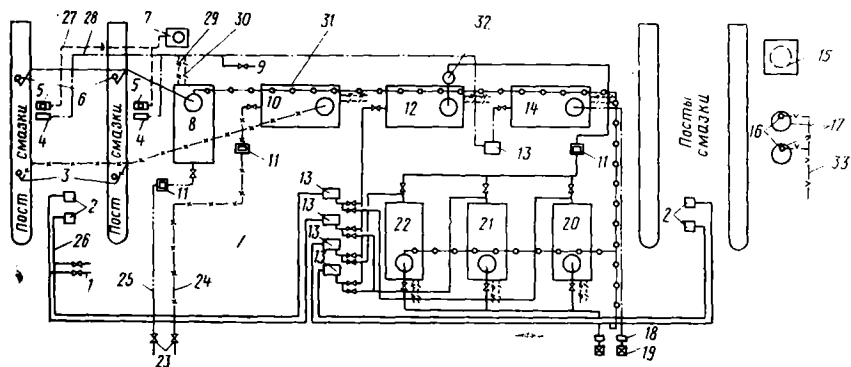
Схема смазочного хозяйства для централизованной подачи и сбора масла:
